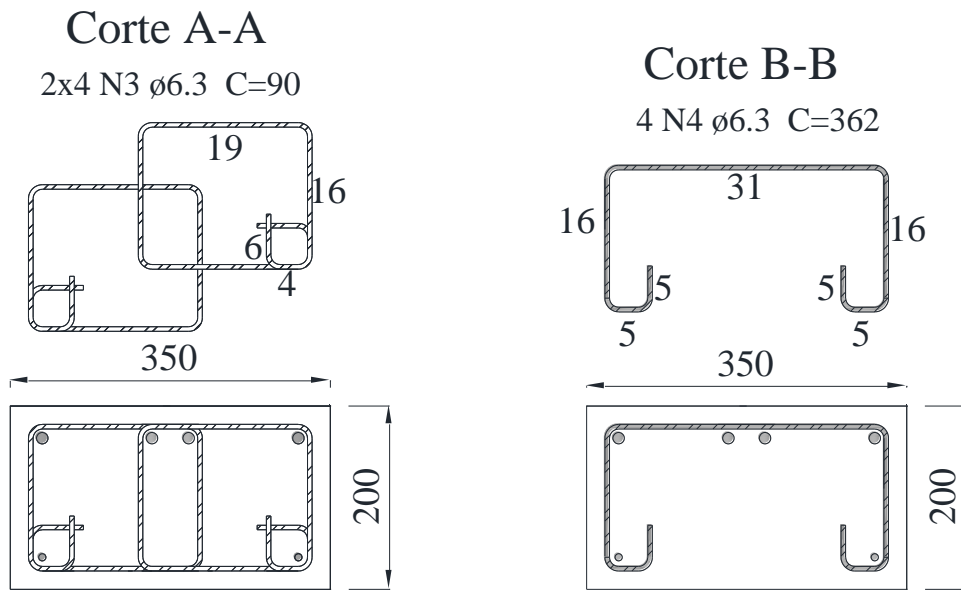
Detalhamento transversal do espécime da primeira etapa de ensaio
